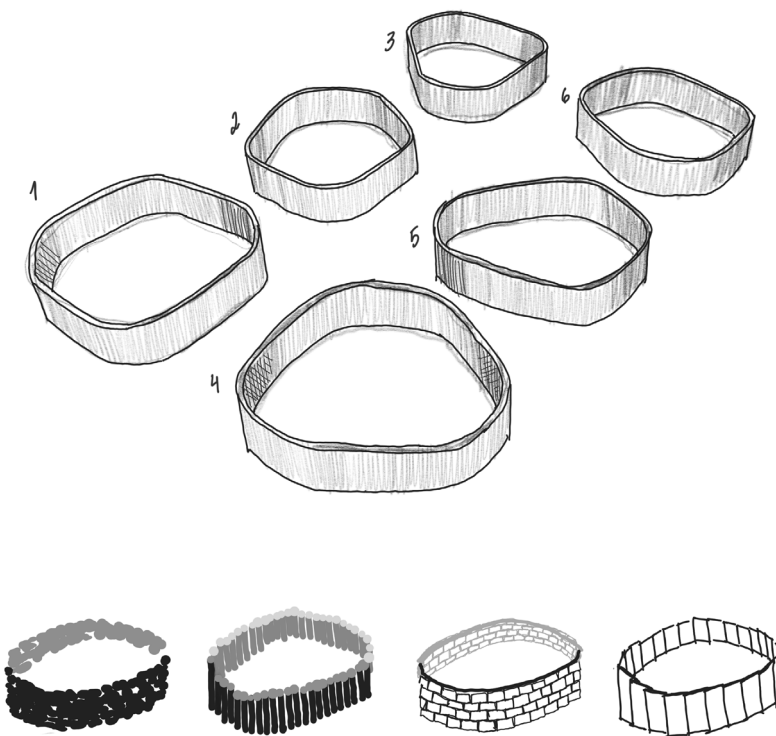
Os seis pré-moldados em concreto utilizados na proposta formando as "parcelas multifuncionais". Previamente serão assentados no terreno existente e com o espaço externo preenchido por brita. Nesse espaço de circulação, além da brita para a drenagem de águas pluviais, também foram previstos tubos em PVC perfurados conectados à rede externa de drenagem, criando, desse modo, uma alternativa à drenagem por infiltração em casos de saturação do solo. Na mesma área de circulação e também sob a brita, foram previstas esperas de instalações hidráulicas e elétricas, de forma que todas as parcelas multifuncionais possam ser conectadas, de acordo com a demanda ou função que desempenharem.
